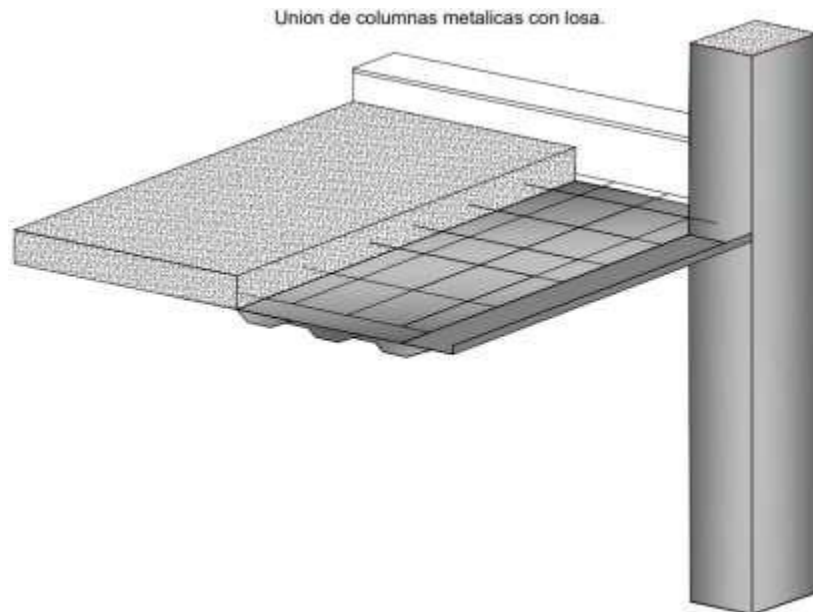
Losa Steel Panel con columna (Redwood & Paredes, 2023)
